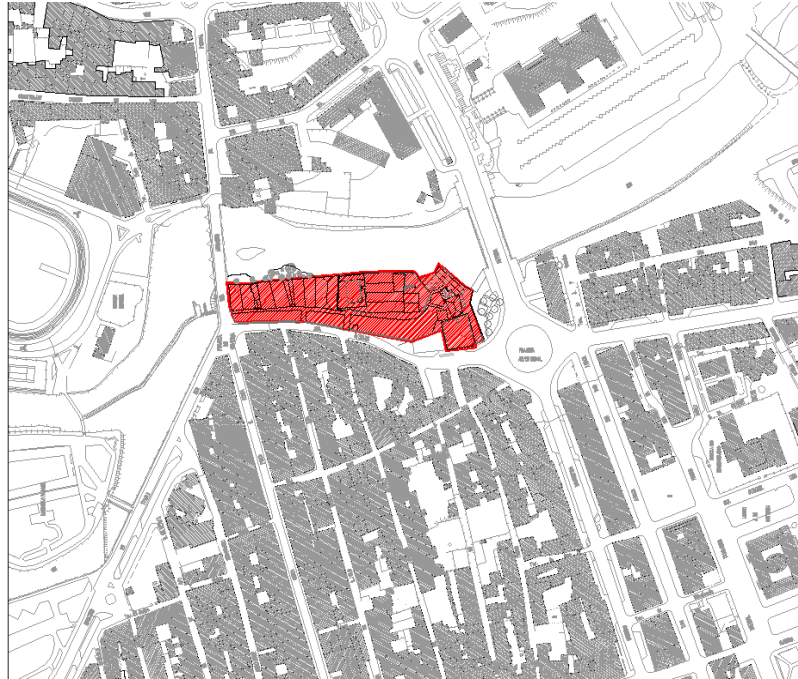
Localização do conjunto edificado na planta da zona envolvente. (CCG Arquitectos Lda.)
